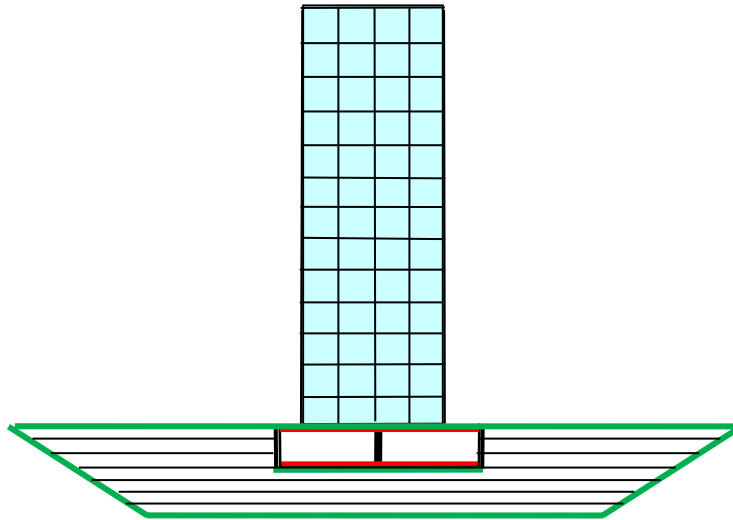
Исследуемая расчетная область системы, состоящей из здания, фундамента и грунтового основания анизотропного строения
